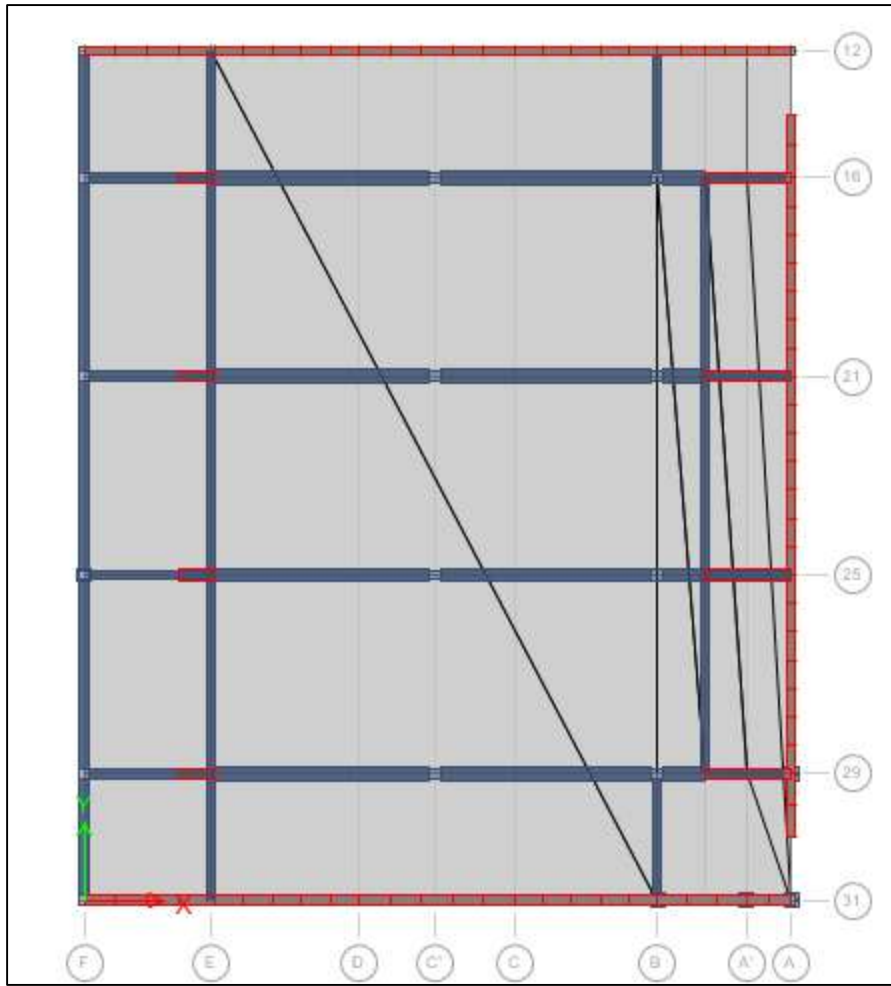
Planta N+2.17 Estructura 6 Coliseo
